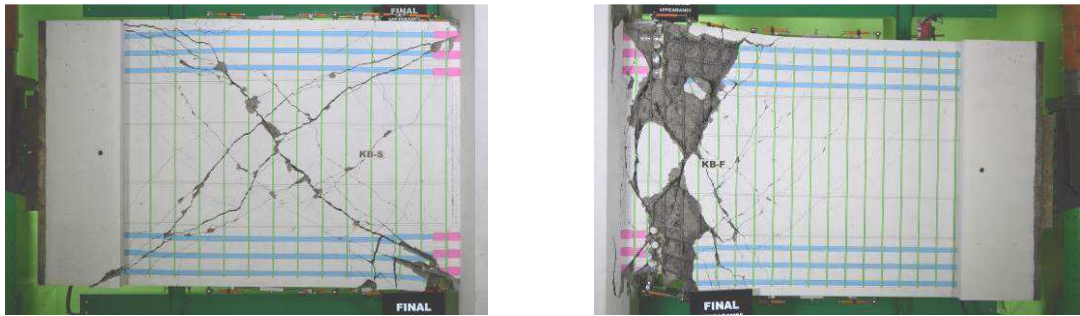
実験終了時破壊状況 (左: 試験体 KB-S, 右: 試験体 KB-F)
